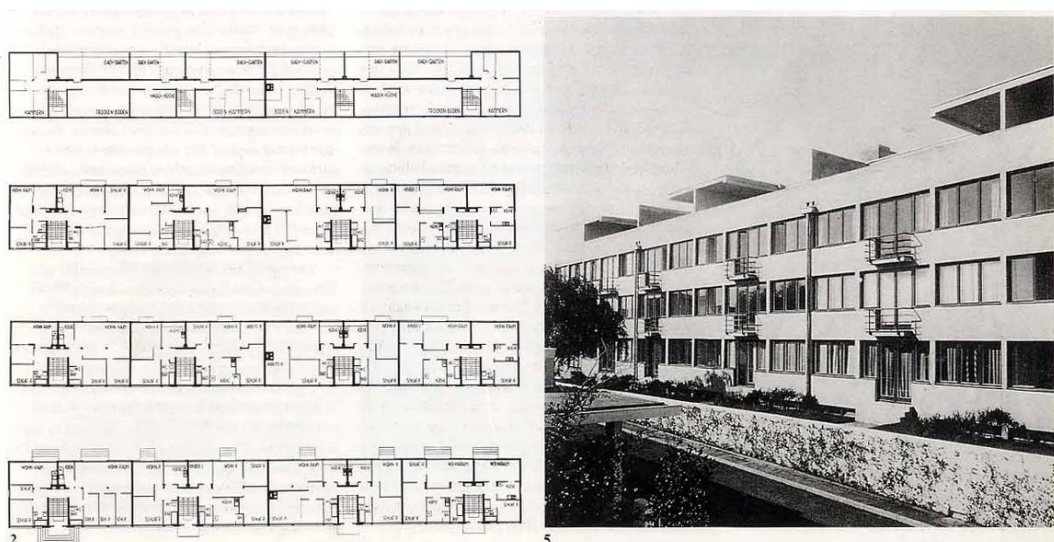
A la izquierda, planta baja, 1º piso, 2º piso y ático.
